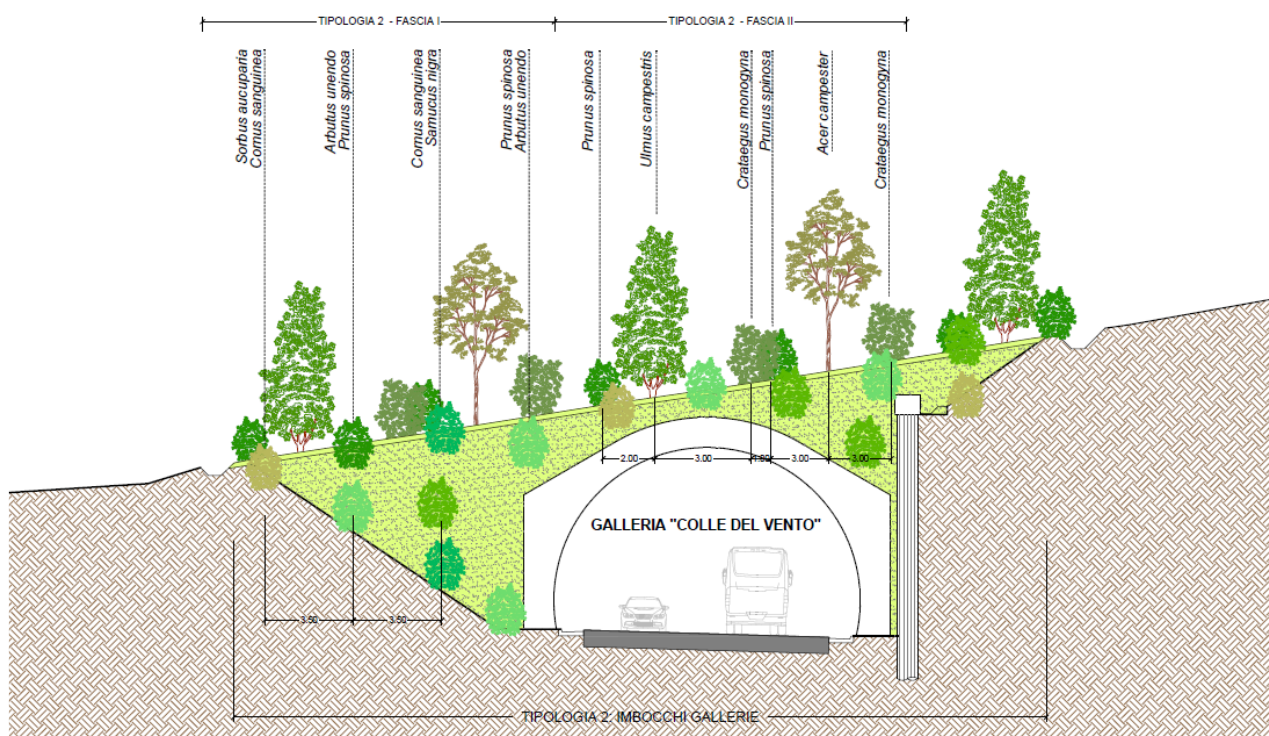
Sezione trasversale Galleria artificiale Colle del Vento.
